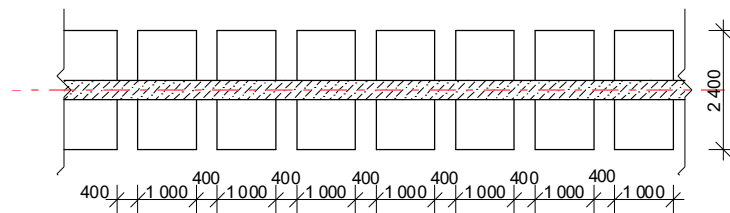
Фрагмент плану стрічкового монолітного фундаменту з розривами (2 варіант) по осі Д
